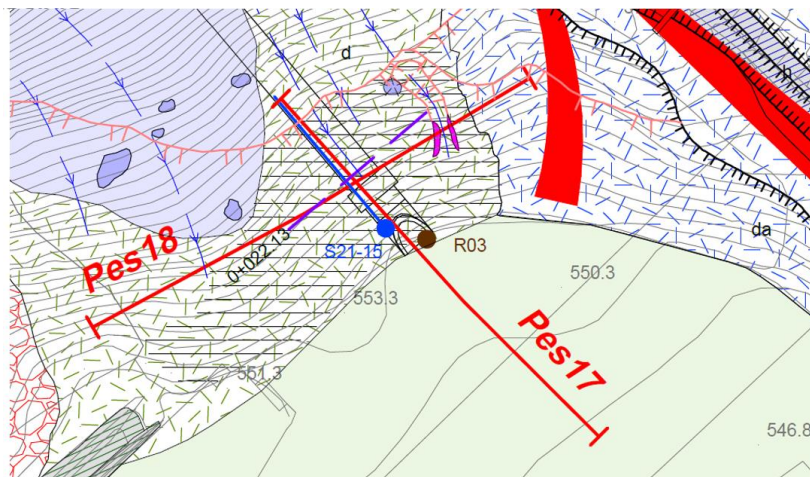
Stralcio planimetrico dell'elaborato BOU1BEZZL7GE0001007A (piano-profilo dell'imbocco ex Finestra di Albes) con l'ubicazione delle linee sismiche di PD e del sondaggio integrativo S21/15.
